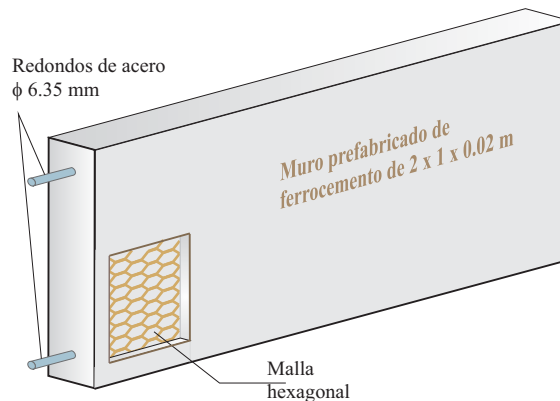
Esquema de refuerzo del muro prefabricado de ferrocemento de 2 x 1 x 0.02 m. (Sin proporción de escala)
